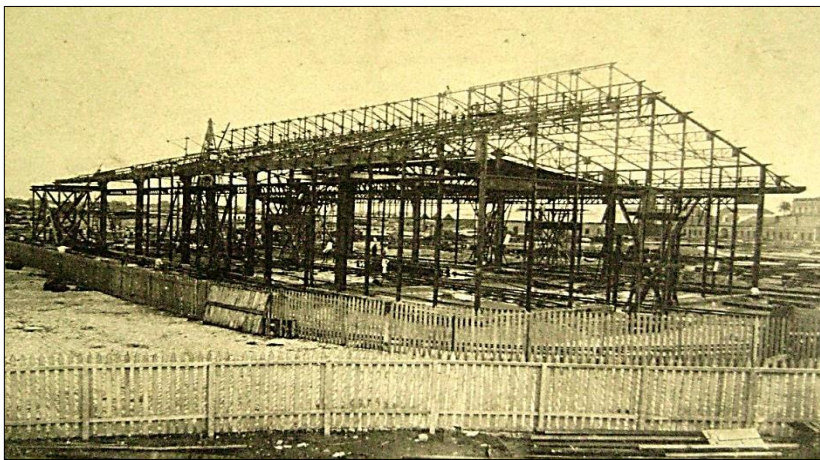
Construção de um dos armazéns de ferro de dois pavimentos junto ao cais. Fotografia.
